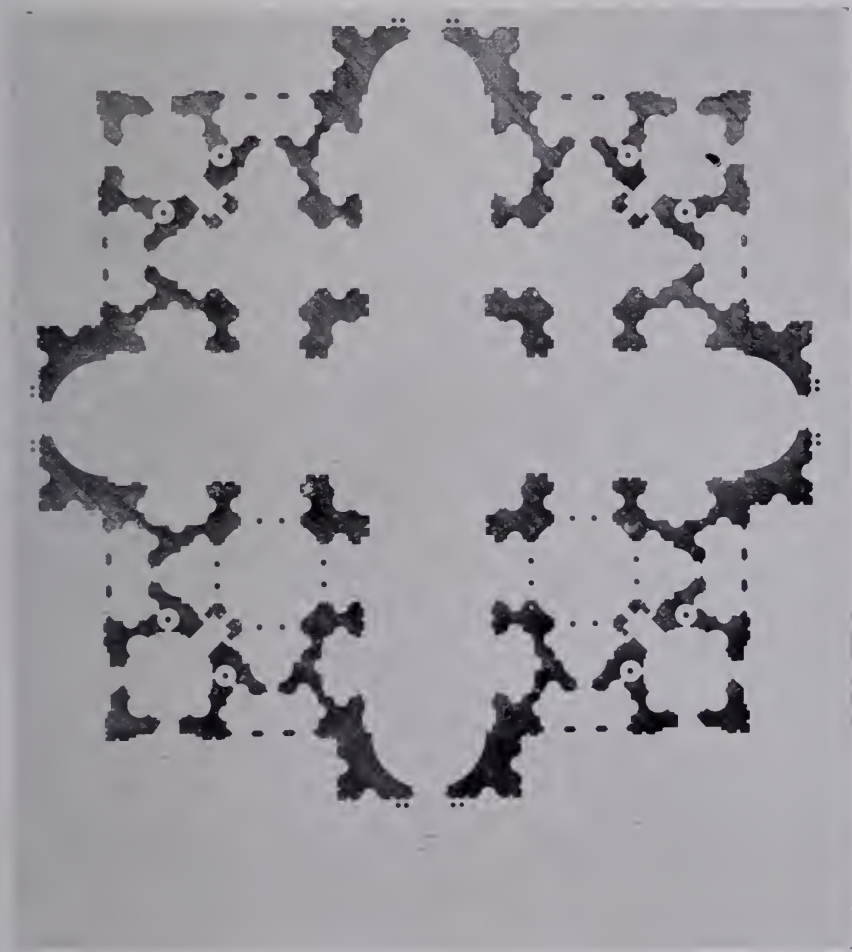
Roma, S. Pietro. Bramante: Pianta ricostruita dal Geymüller.
